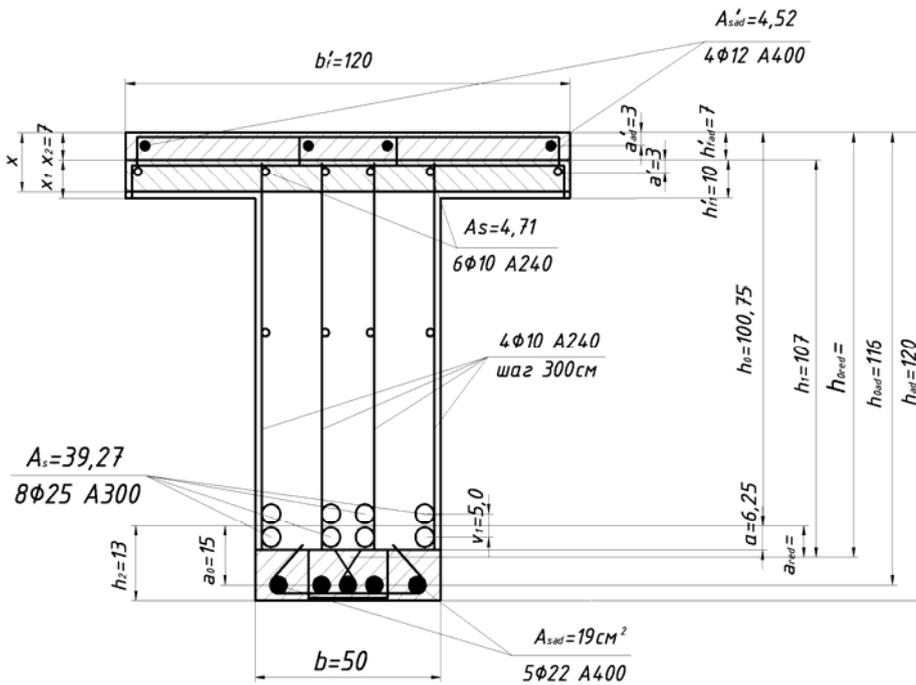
Расчетная схема усиления элемента таврового профиля двусторонним наращиванием ($x \leq h'_f$)
